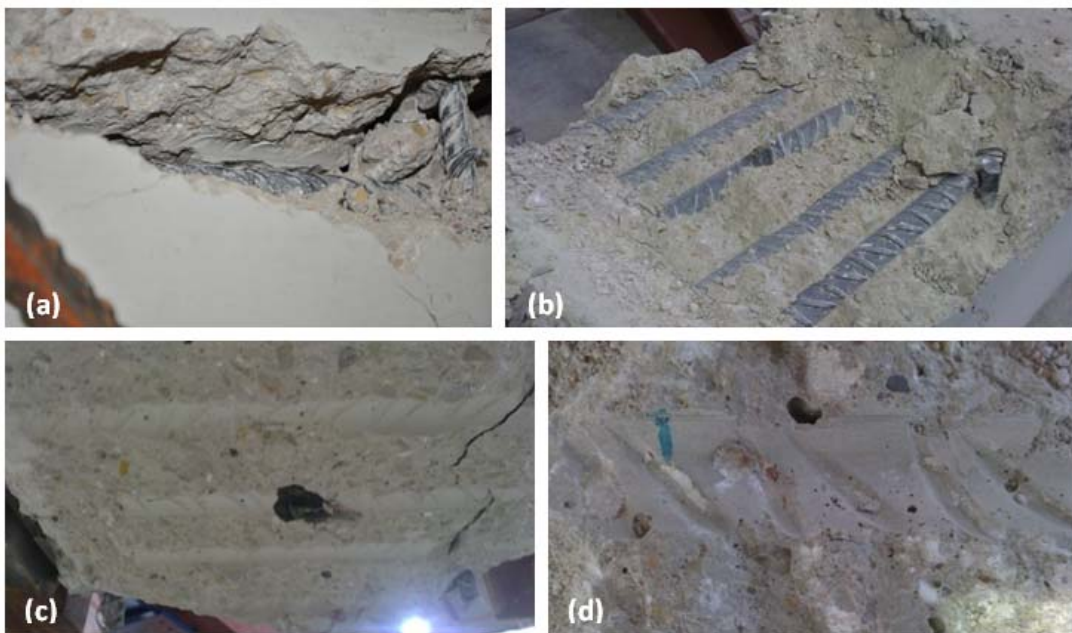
Fisura de entronque pilar-nudo. Probeta S.DB.L0: a) fisura durante la flexión del pilar, b) sección donde se produce la fisura, c,d) corrugas de las armaduras de las vigas marcadas sobre sección de columna
